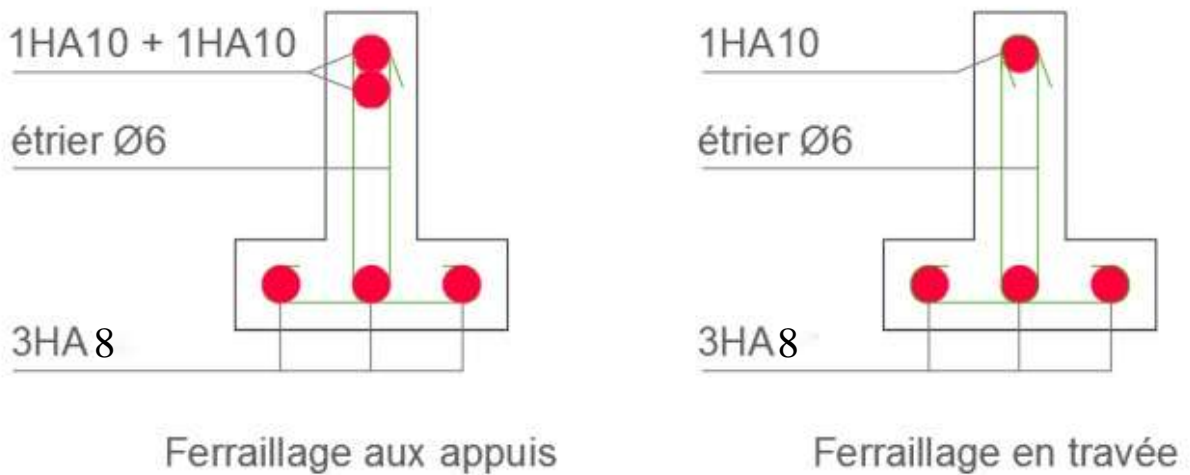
Schéma du ferrailage du plancher type 1.
